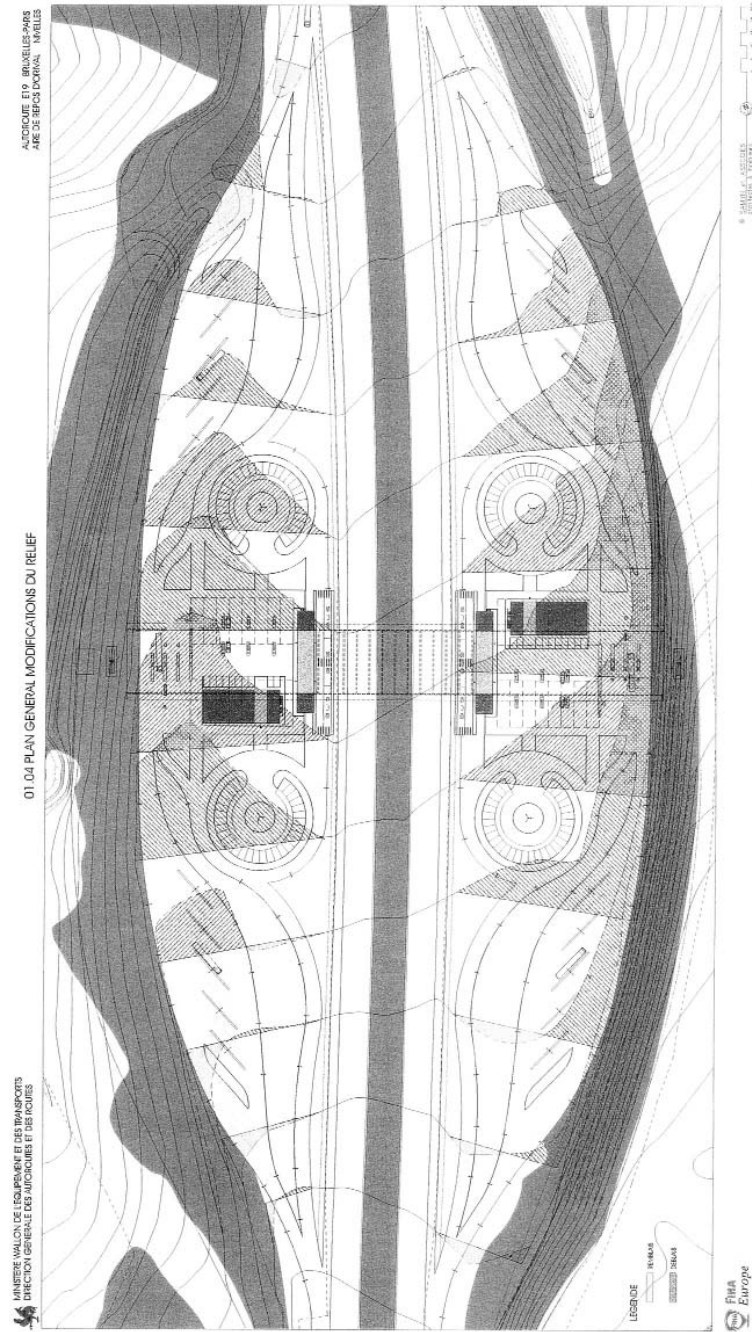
Planimetria con indicazione dei movimenti terra per la sistemazione dell'area (Samyn & partners)
